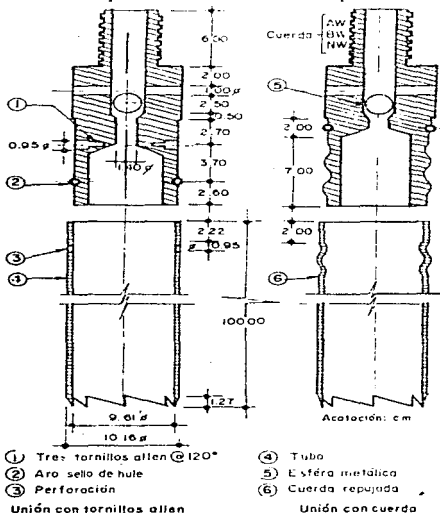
MUESTRADOR DE TUBO DENTADO
